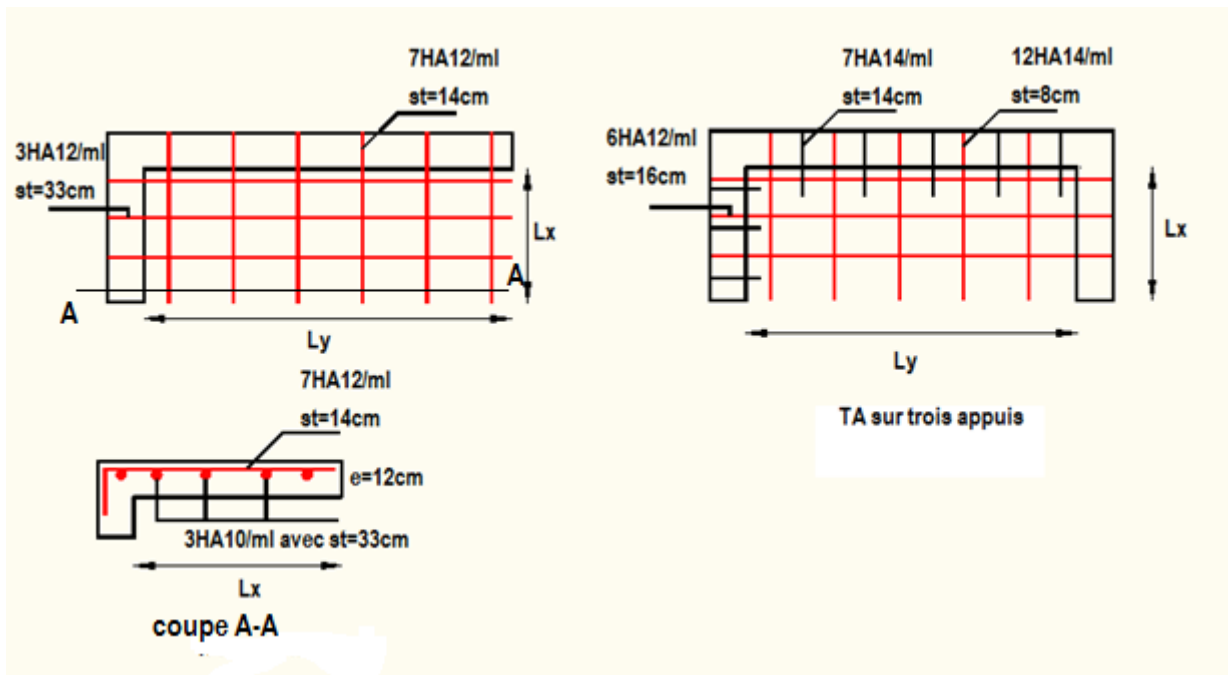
Schémas de ferrailage de la terrasse accessible
